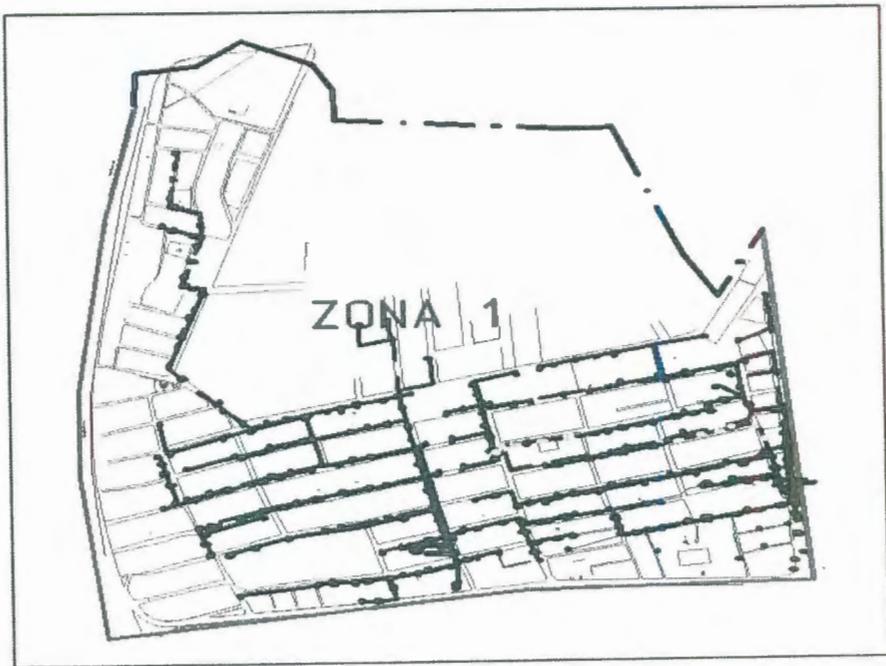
Planimetría zona 1 del sector de la vía a Daule
